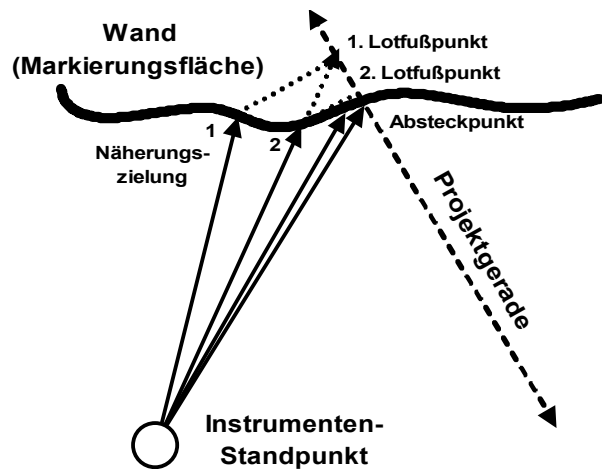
Detail (Grundrissdarstellung)
